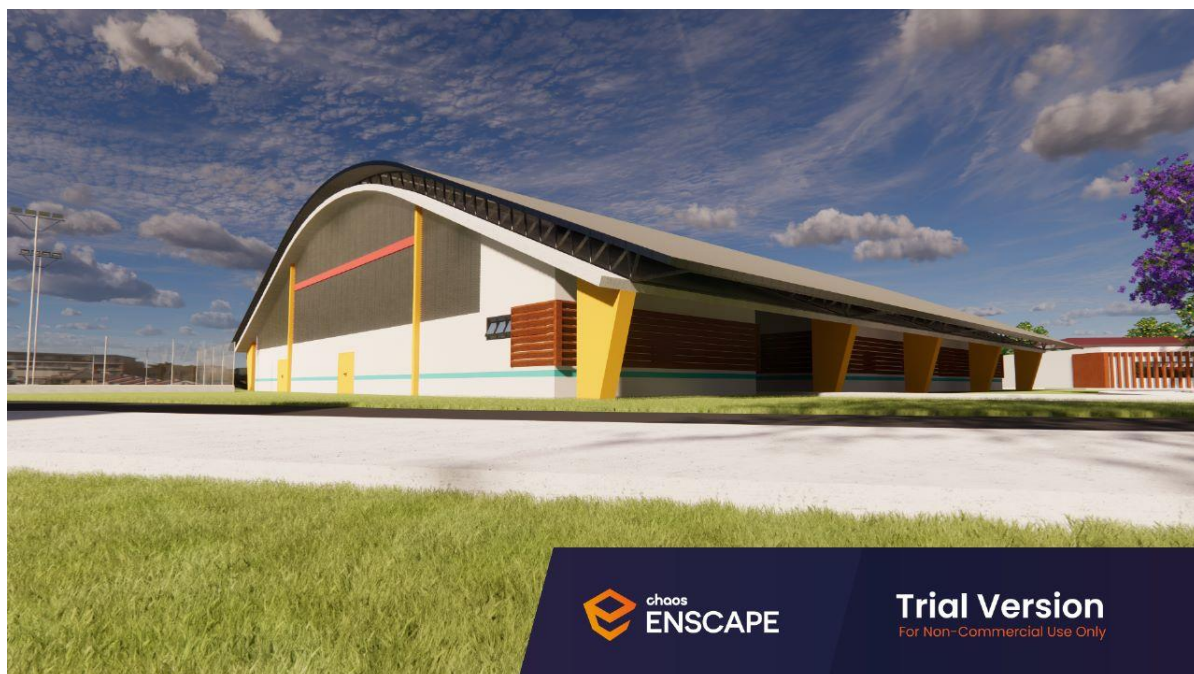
FOTOS PROJETO: Fachada da Quadra Poliesportiva coberta.
